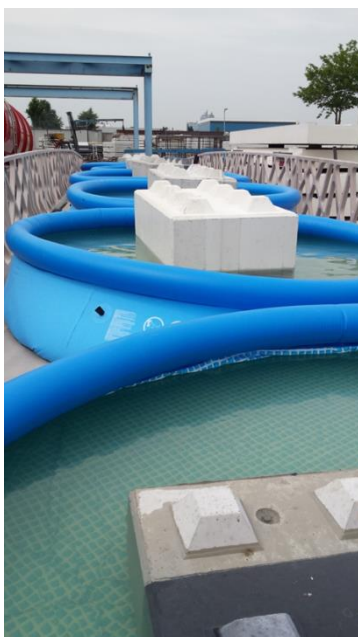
Opstelling belasting met waterbakken en betonblokken op het dek
